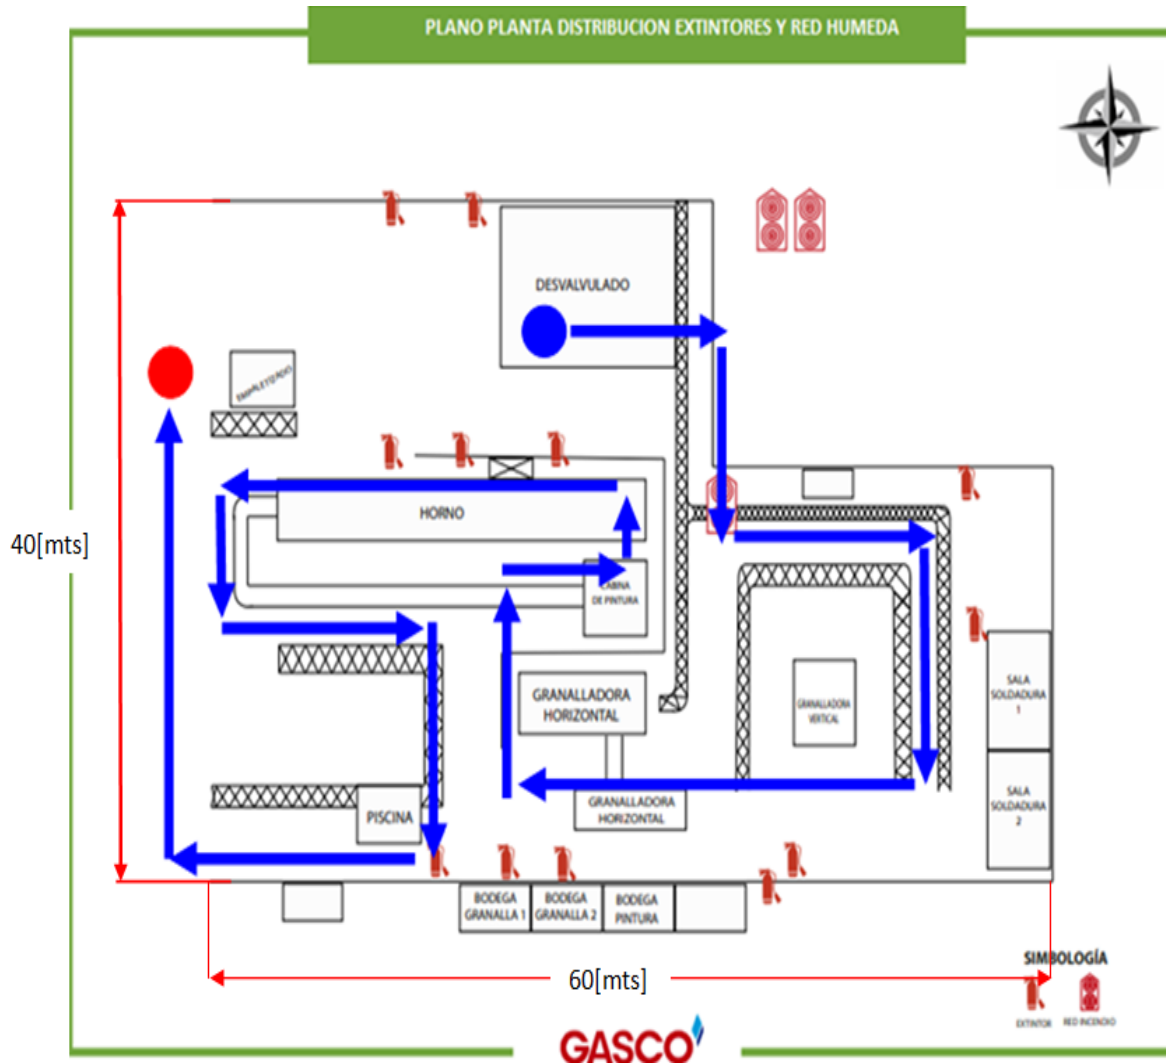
,20. Lay-Out de la planta ECSE Maipú
